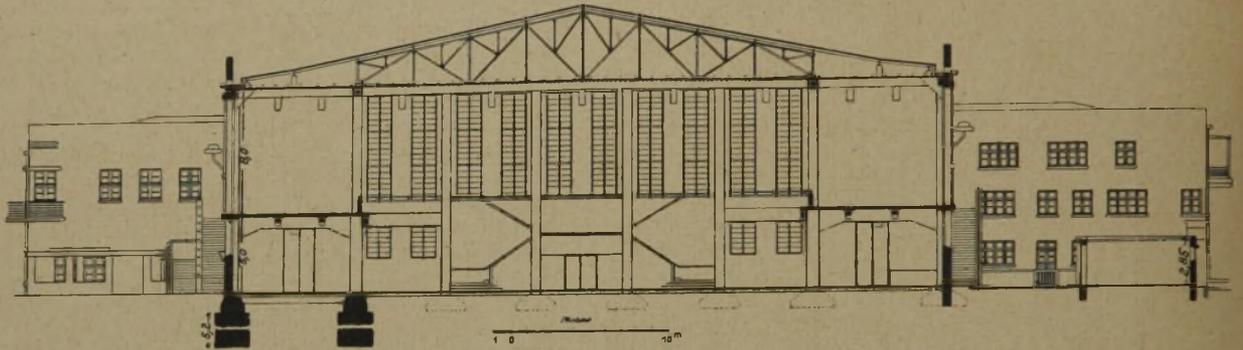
Querschnitt mit Blick nach dem Eingang von der Dessaustraße (1:500).
